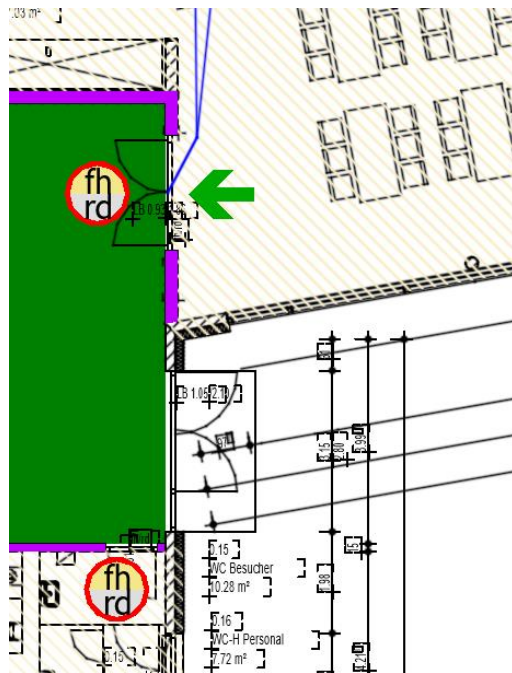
Ausschnitt Grundriss EG/ Achse X/3
